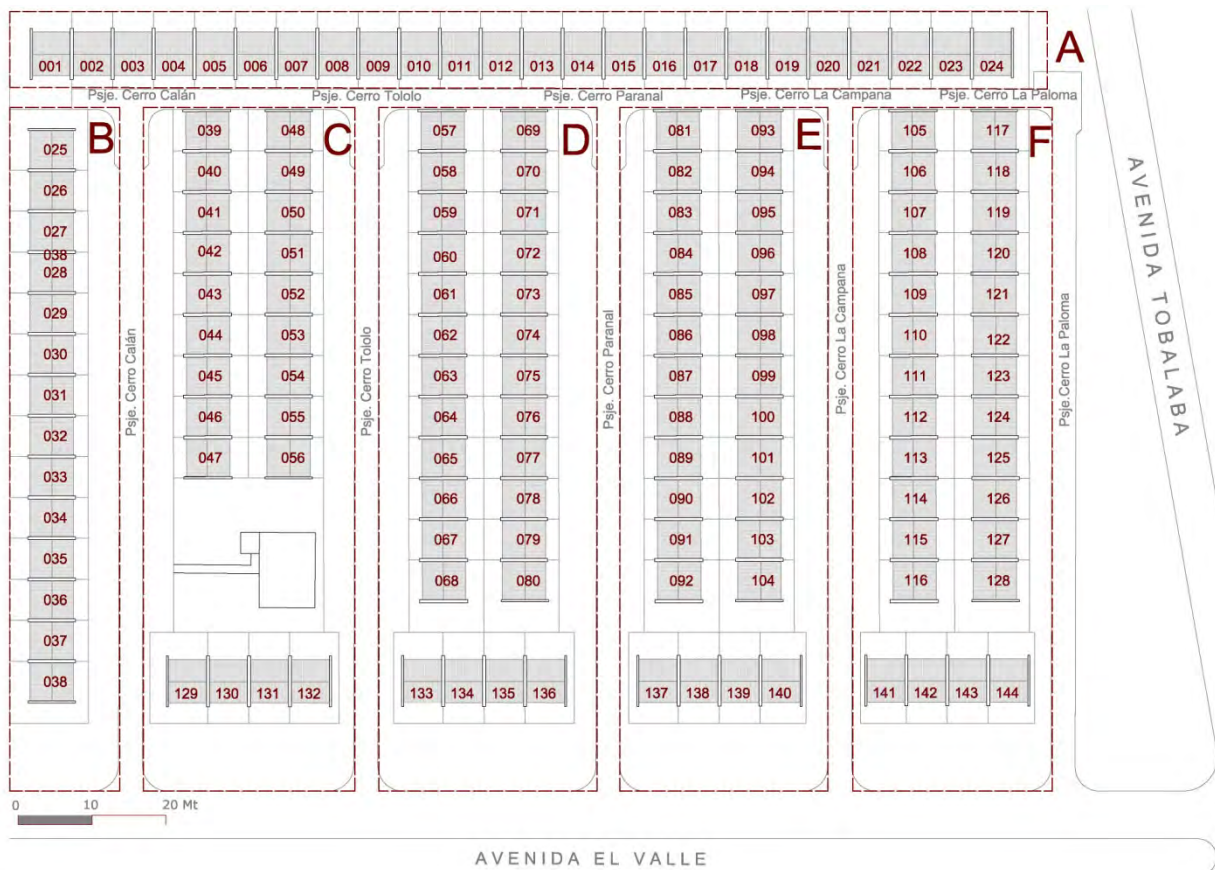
El conjunto habitacional, las 144 viviendas y la división en seis zonas
